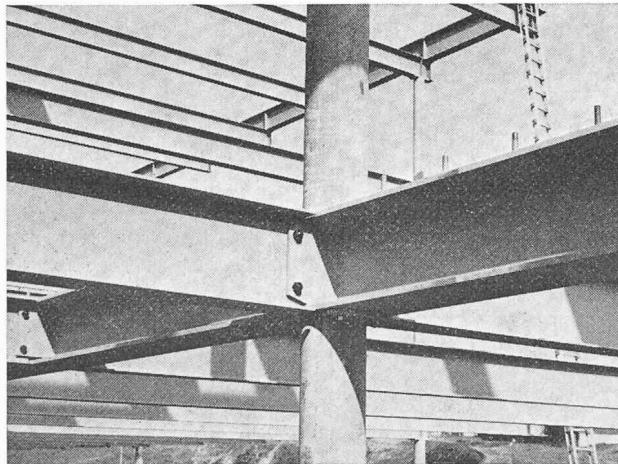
Assemblage normalisé d'une poutre secondaire sur une poutre maîtresse au voisinage d'une colonne. Le couvre-joint de la poutre secondaire forme en même temps raidisseur, permettant de reprendre la réaction d'appui de la poutre maîtresse continue.
